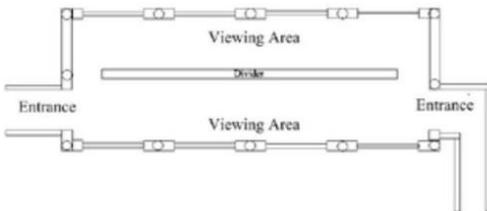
Planta C. Fuente: Ernst Retief, 2013, A Guide To Building Universally Accessible Bird Hides
